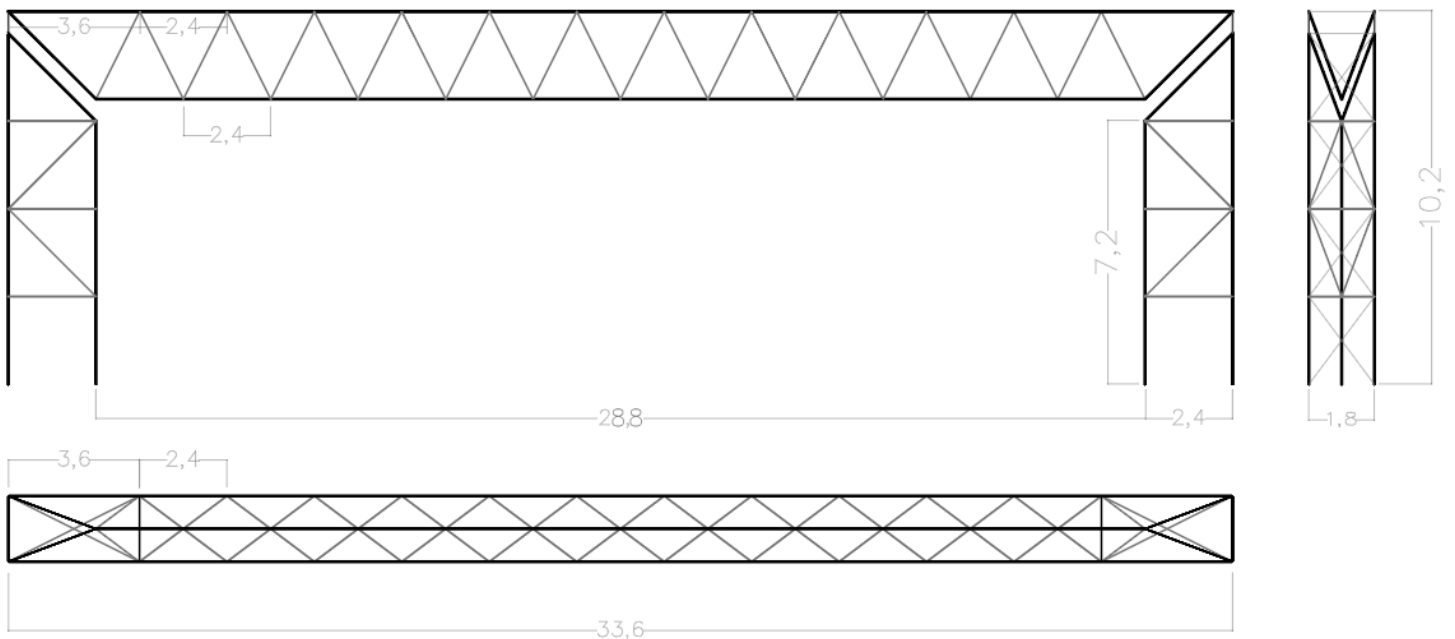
ESQUEMA ACOTADO DE ALZADO, PLANTA Y PERFIL DE UN PÓRTICO TIPO. ELABORACIÓN PROPIA.
